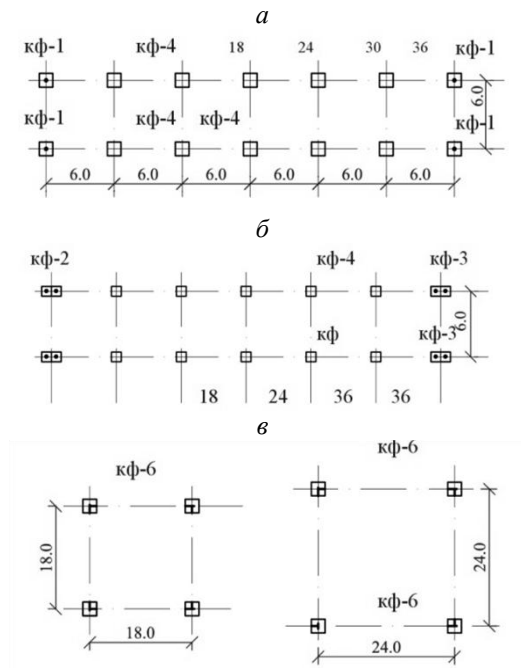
План фундаментов: а – вариант без мостовых кранов; б – вариант с мостовыми кранами; в – структурных плит
